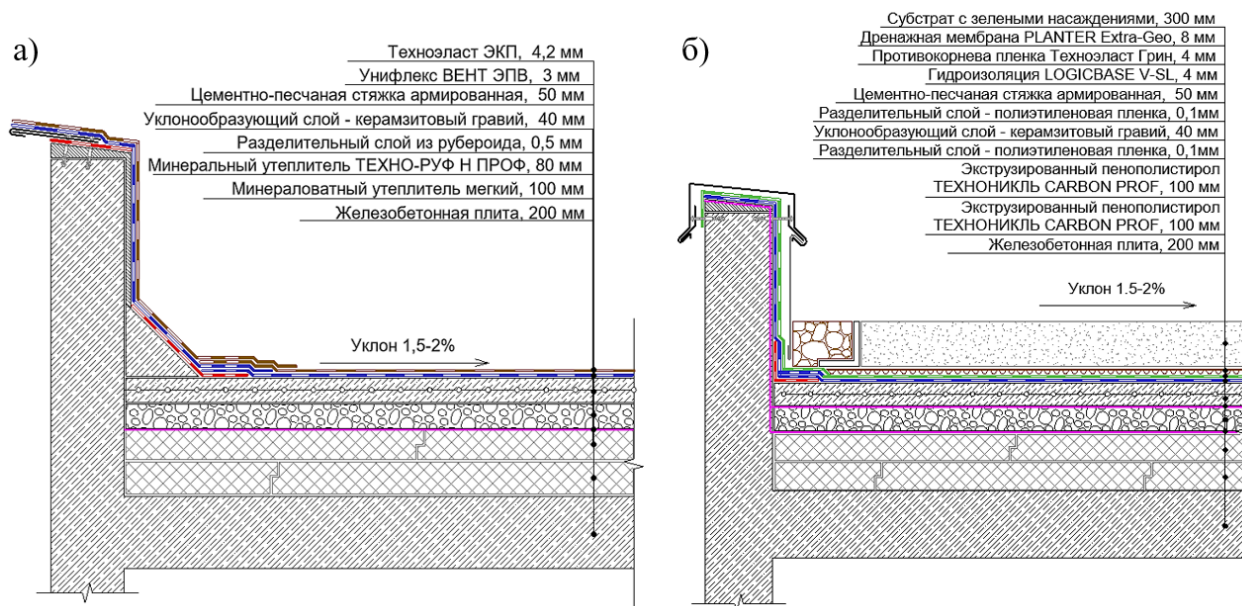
Устройство кровли: а – стандартная кровля; б – «зеленая» кровля
